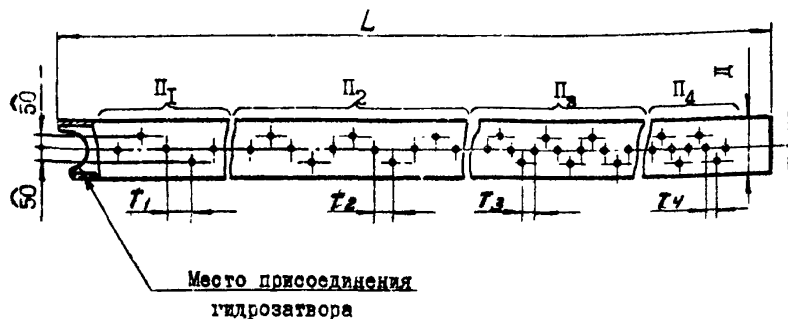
Схема расположения отверстий (вид снизу) и основные размеры перфорированного трубопровода коллектора ввода очищаемой воды
